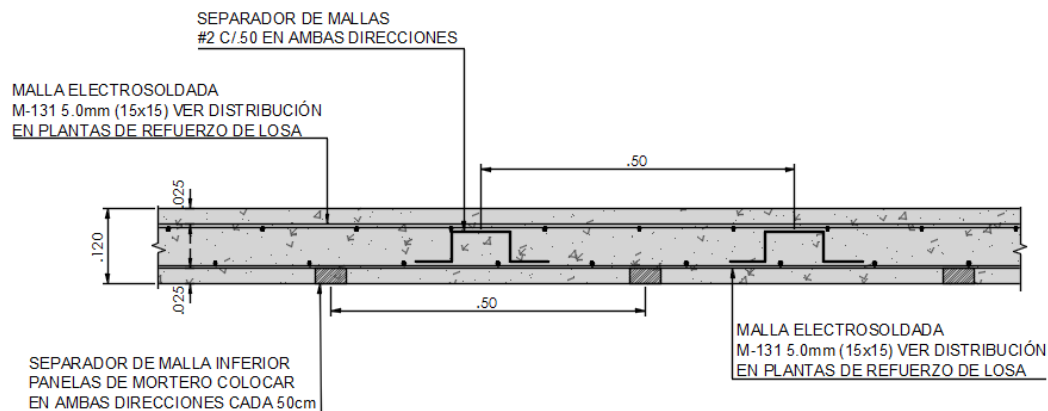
Detalle típico de losa maciza. Fuente: Imágenes de planos DUAL INGENIERÍA ESTRUCTURAL SAS. Archivo personal, recuperado en el 2017.
